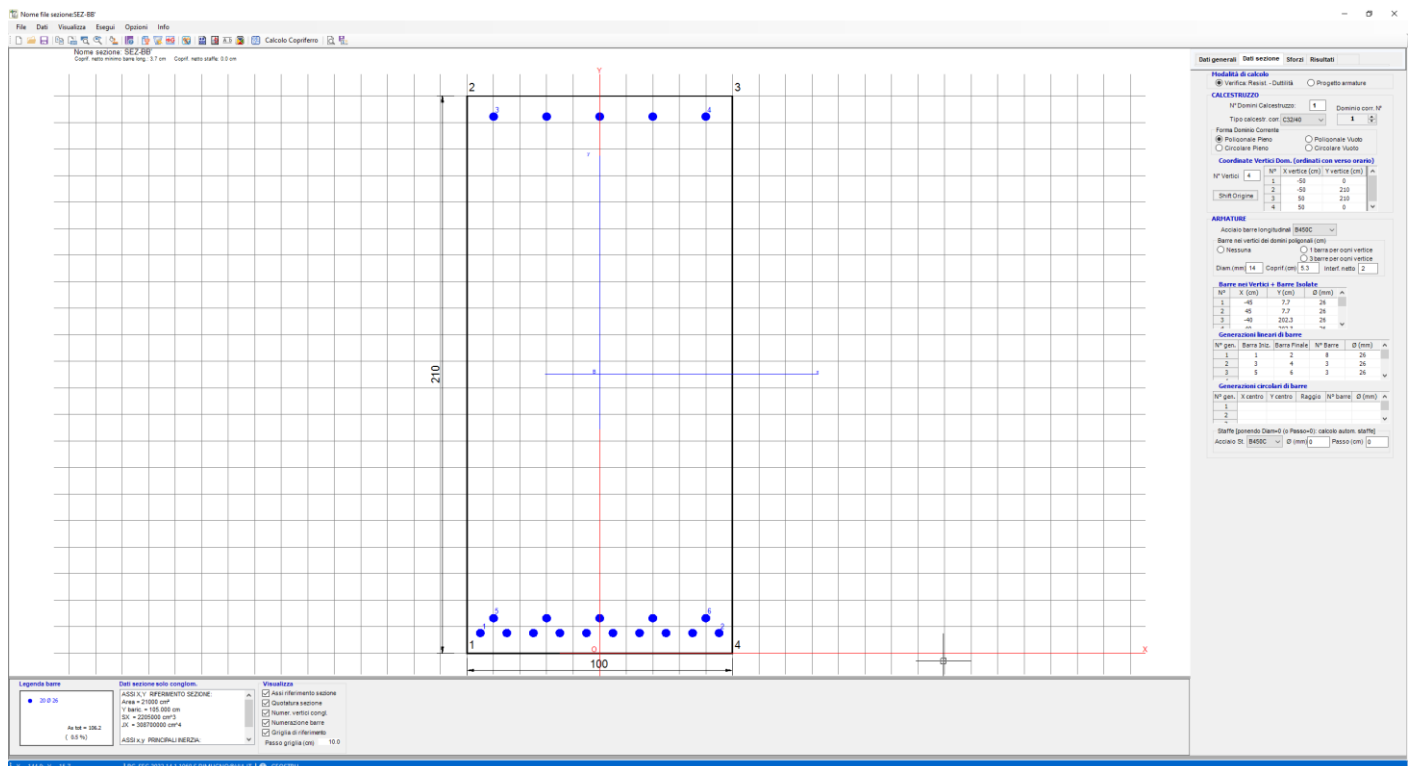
Muro frontale - Geometria sezione di verifica
